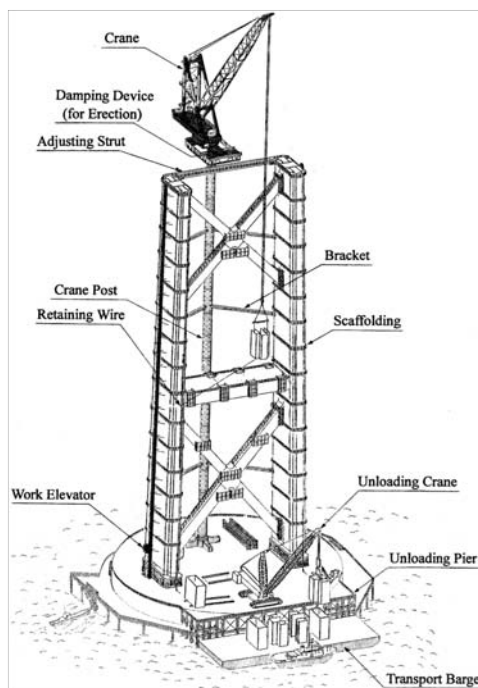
Construção de um dos pilares da Akashi Kaikyo Bridge (Honshu-Shikoku Bridge Authority, Akashi Kaikyo Bridge – Engineering Note, Japan, 1992 in Okukawa, A. et al (2000))
